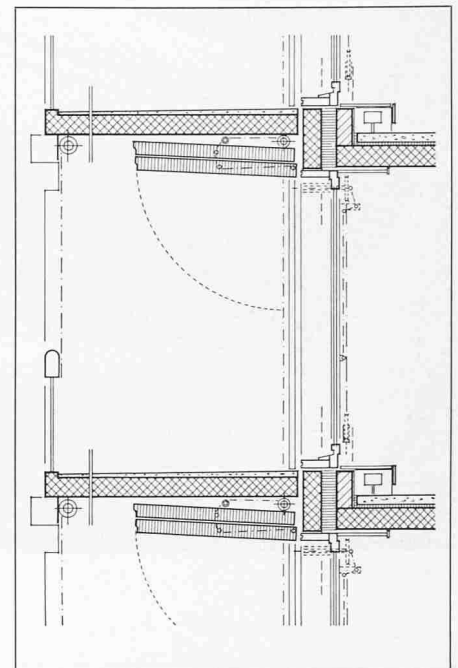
Wärmedämm-laden für den Wohnungsbau. Vertikalschnitt durch Wohnzimmer und Balkon eines Mehrfamilienhauses. Der Laden entspricht dem Modell C
